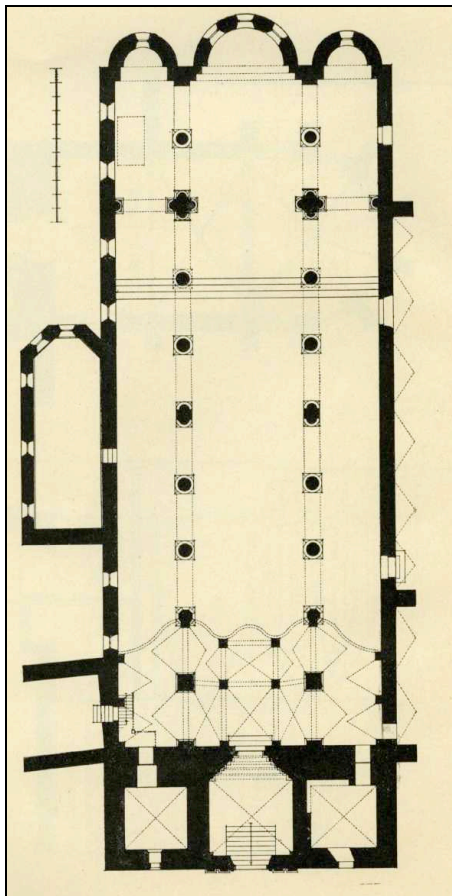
Seckau, Stiftskirche, Grundriss um 1960, 1: 12.
